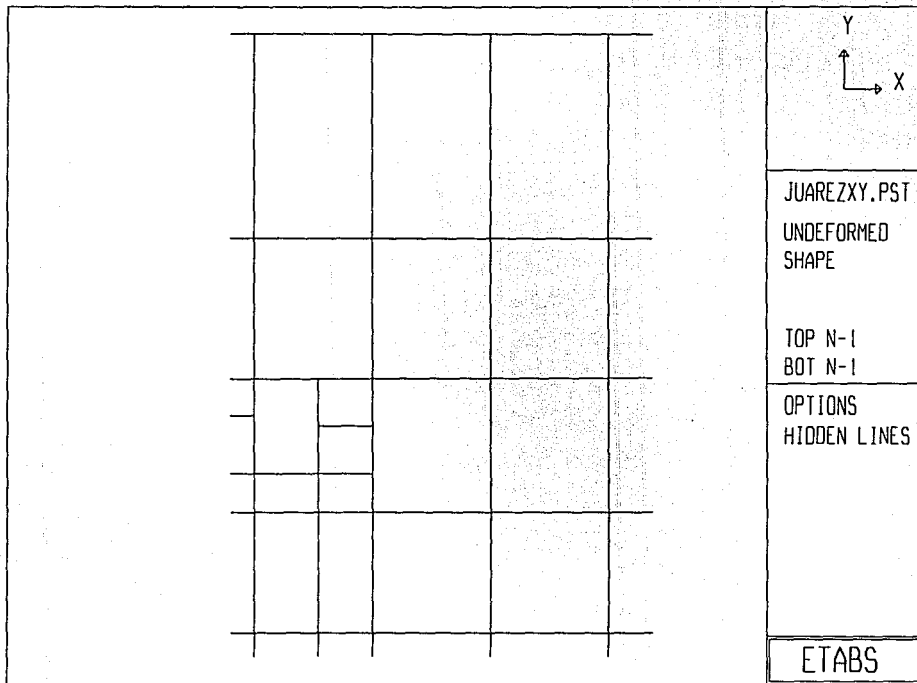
f VISTA EN PLANTA DEL NIVEL DE ACCESO PARA ETABS
